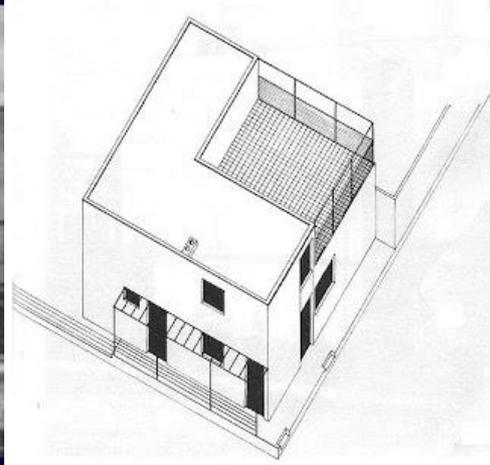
Axonometria da Casa do Bairro Operário de Weissenhof.
